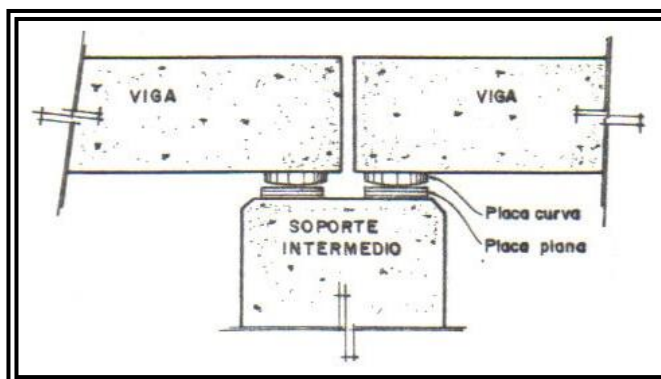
62 Apoyos móviles a base de placas metálicas.
